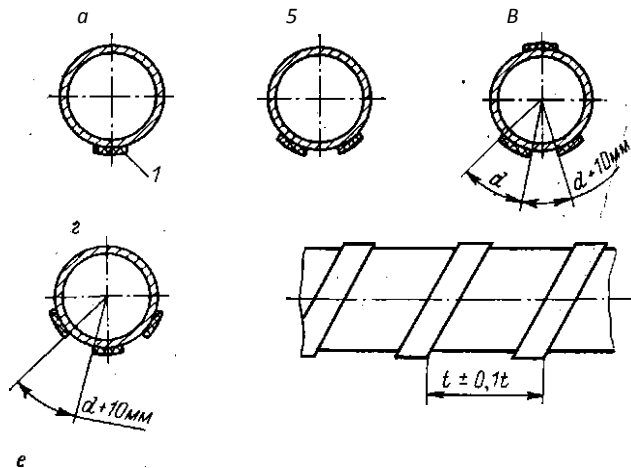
Примеры обозначений установки ЭНГЛ-180 на трубопроводе.
